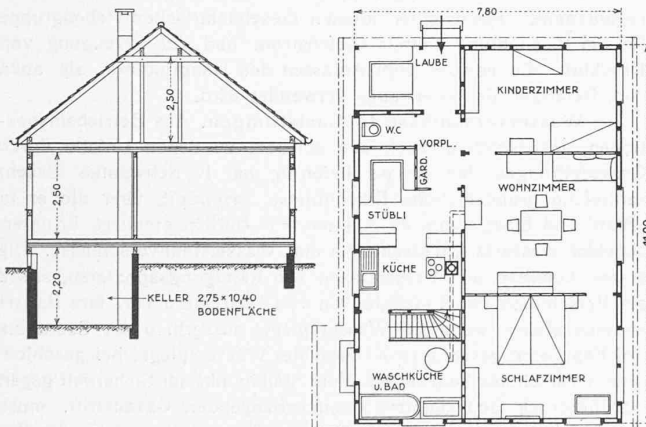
Schnitt und Grundriss des Kleinhauses. — Masstab 1 : 200.
